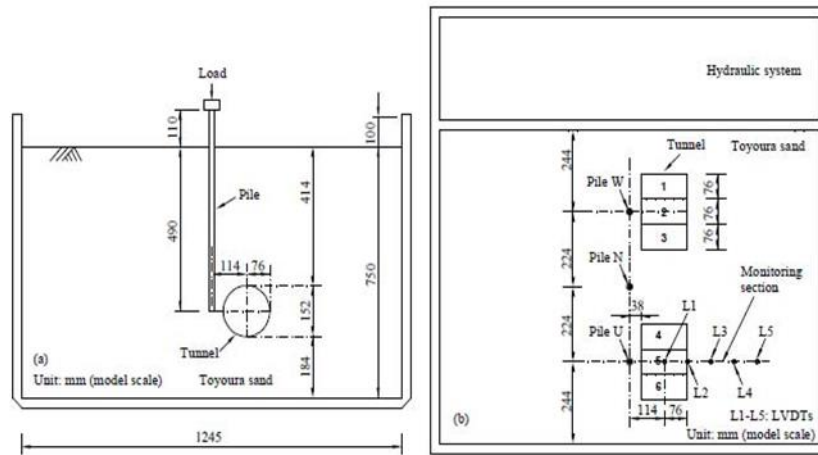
Schéma en coupe (a) et en plan (b) du dispositif expérimental de Peng et al., (2011)
